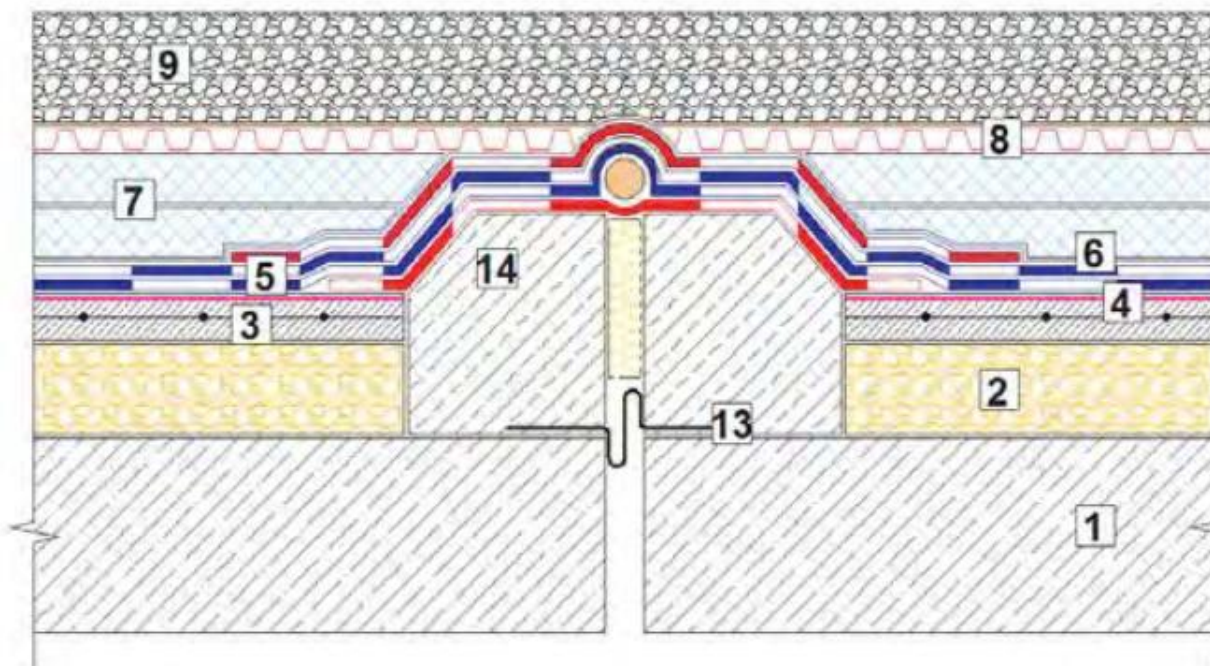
Деформаційний шов, де: 1 – з/б плита перекриття; 2 – схилоутворюючий шар із керамзитового гравію; 3 – армована цементно-пісчана стяжка; 4 – праймер бітумний; 5 – гідроізоляційний шар; 6 – голкопробивний геотекстиль 300 г/м²; 7 – екструзійний пінополістирол щільністю 35 кг/м³; 8 – дренажна мембрана; 9 – баласт; 13 – металевий компенсатор; 14 – кладка.
